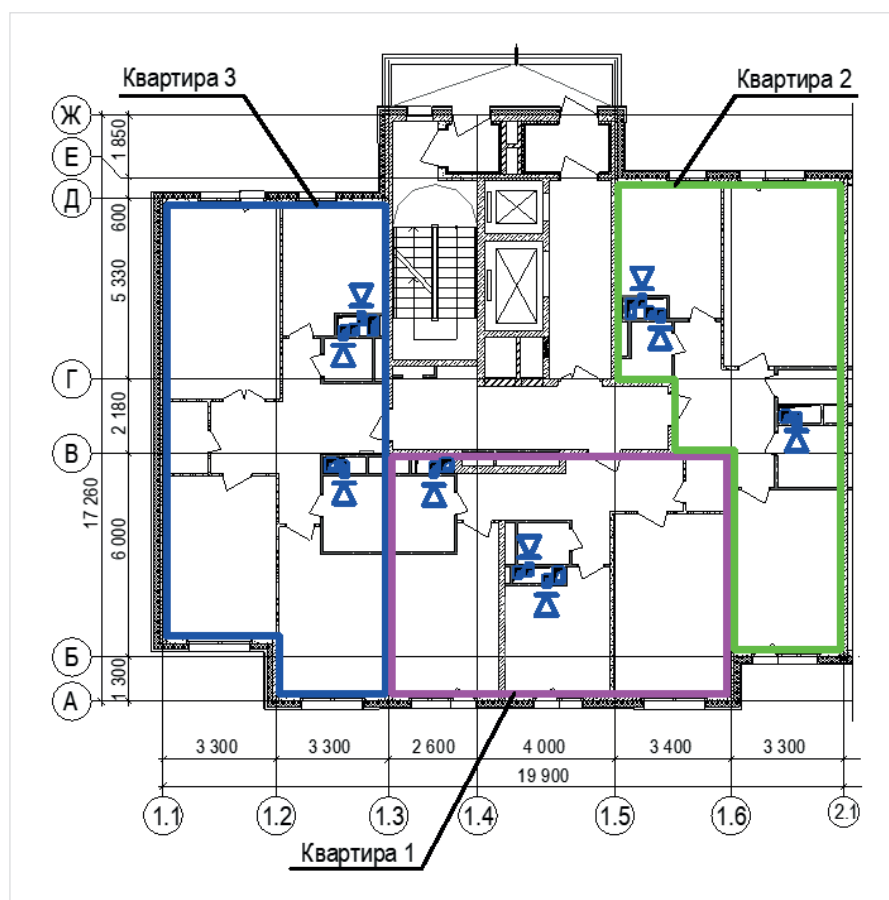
План типового этажа секции девятнадцатизэтажного жилого дома
